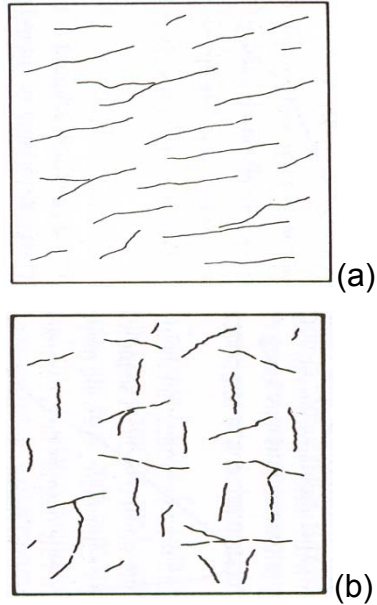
Esquemas de fisuración por retracción plástica
